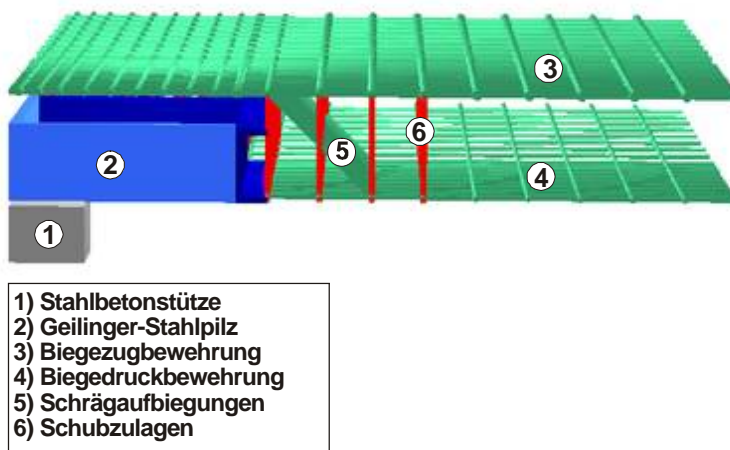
Geilinger-Stahlpilz und Bewehrungsführung
